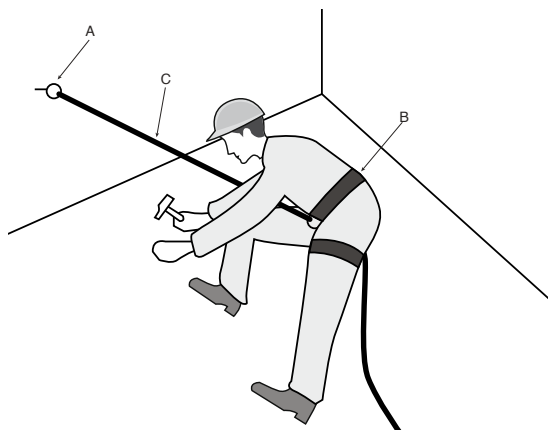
Schematizzazione del sistema di posizionamento sul lavoro
